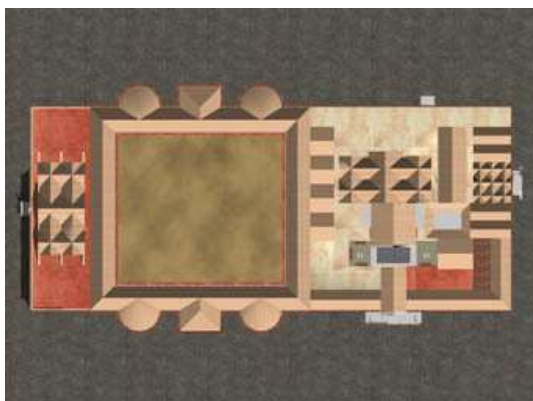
y 134. Planta y fachada ¾ del exterior de la Casa del Planetario.
